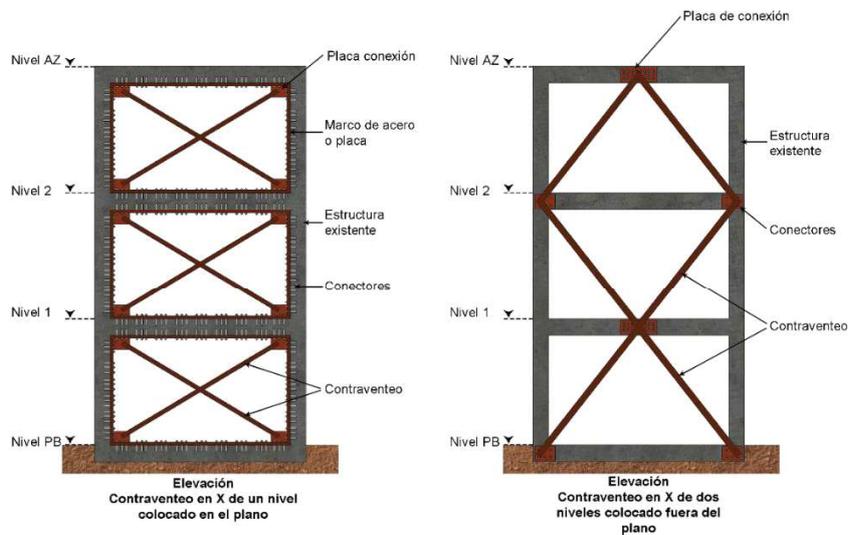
c – Elevación de contraventeos concéntricos y excéntricos (INIFED, 2021d)
